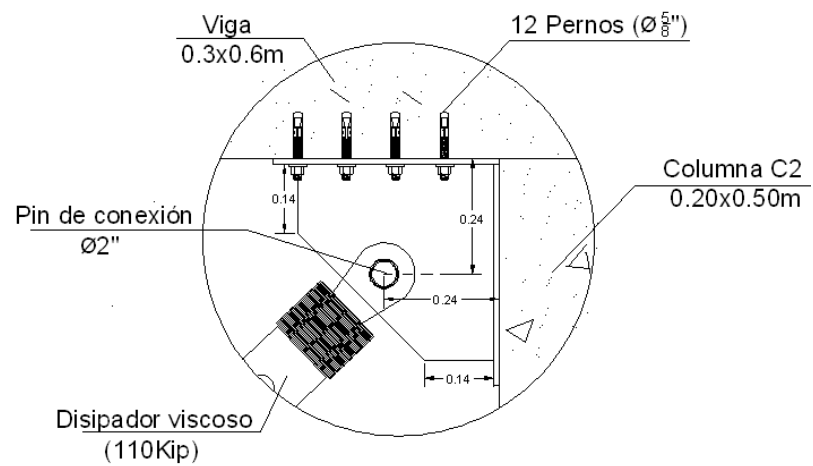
Detalle 2 (Conexión: Disipador – Cartela – Estructura de concreto)
